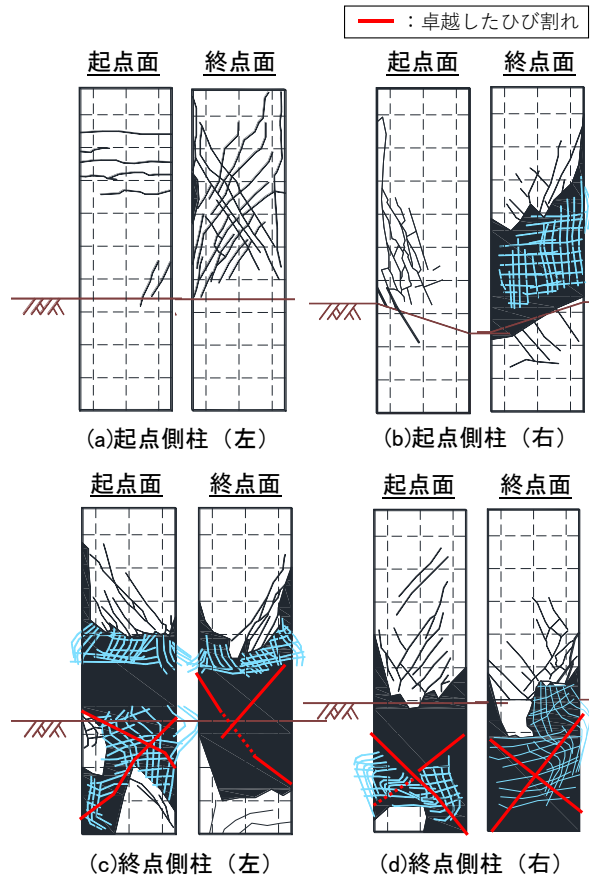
1P 橋台各柱のひび割れ損傷図
